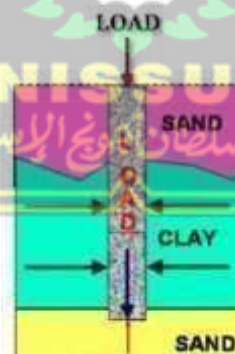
Fondasi Tiang Pancang *End Bearing Pile
